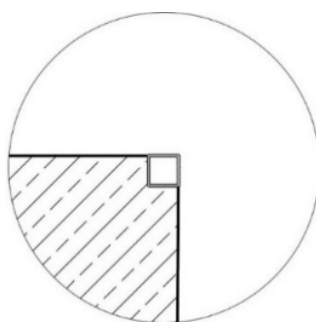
Profil równo „wtopiony” w krawędź elementu. Do profilu przyspawane marki z drutu stalowego w celu pewnego zakotwienia w betonie
